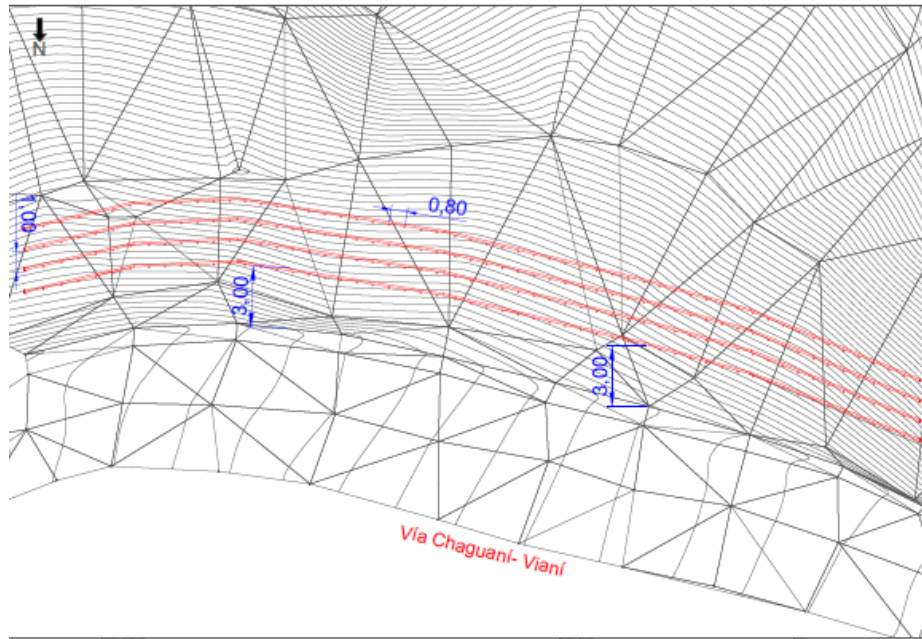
Vista en planta N°2 ubicación de trinchos. Fuente: Propia
